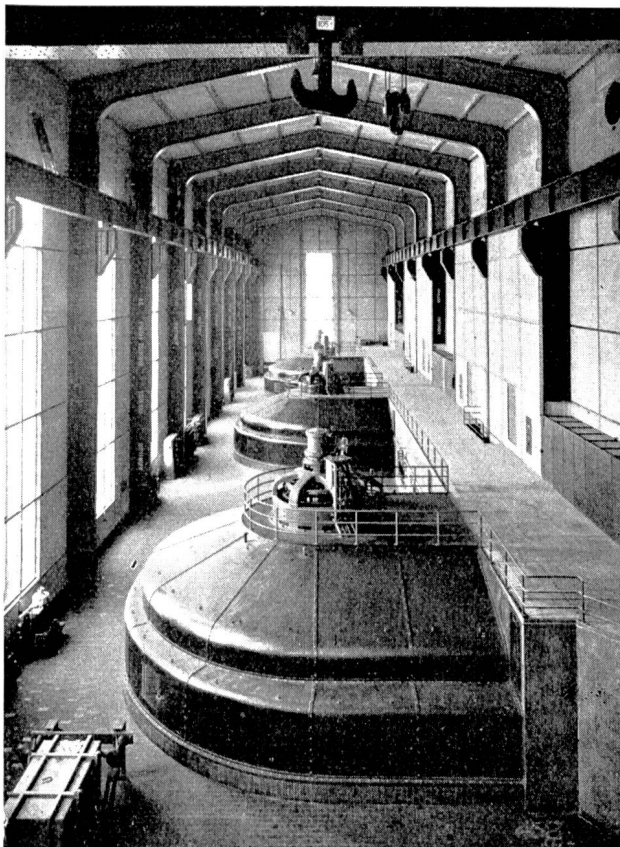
Inneres des Maschinenhauses. Stahlskelettbau; Wände in Backsteinmauerwerk ausgemauert.
